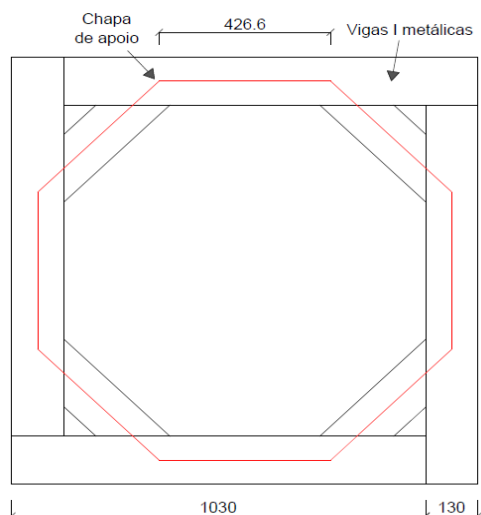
Planta da disposição dos apoios do sistema de ensaio das lajes de Azevedo (1999)
